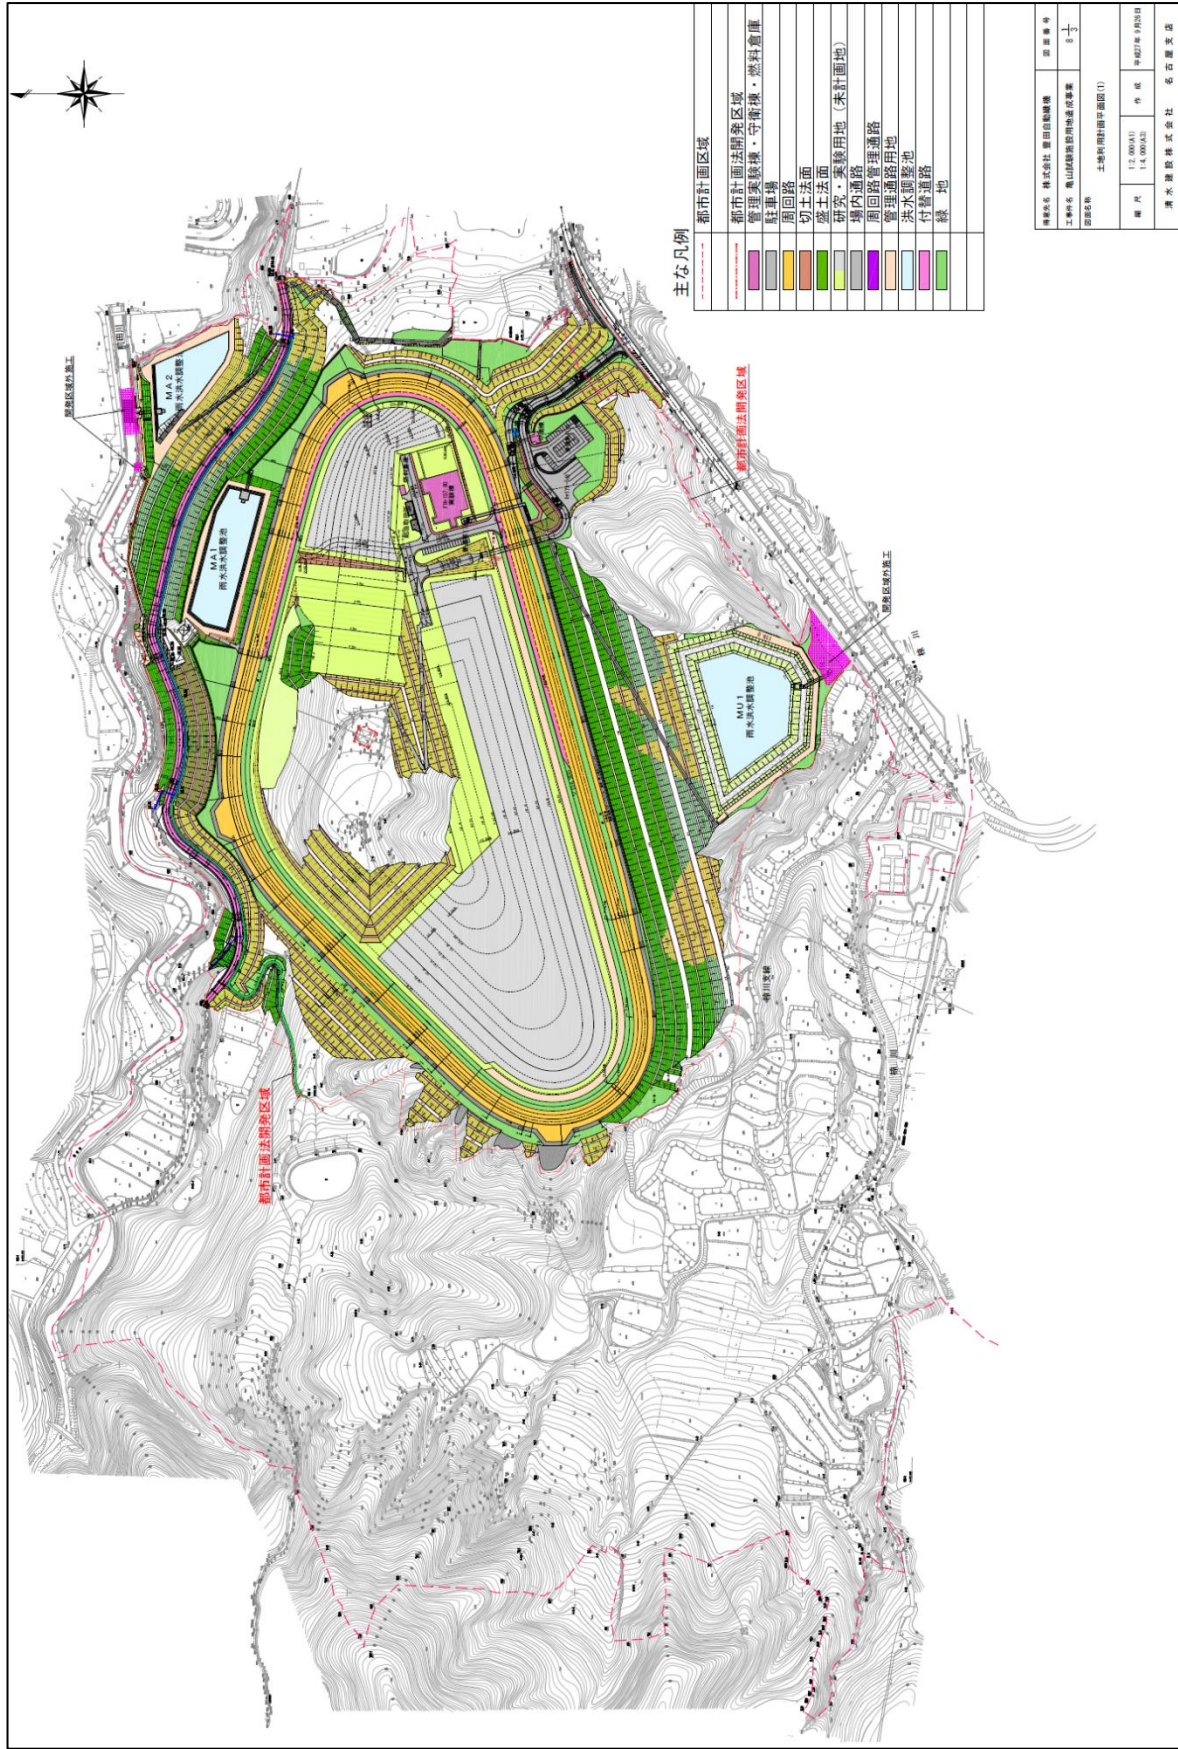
土地利用計画平面図 (第 2 回変更)
